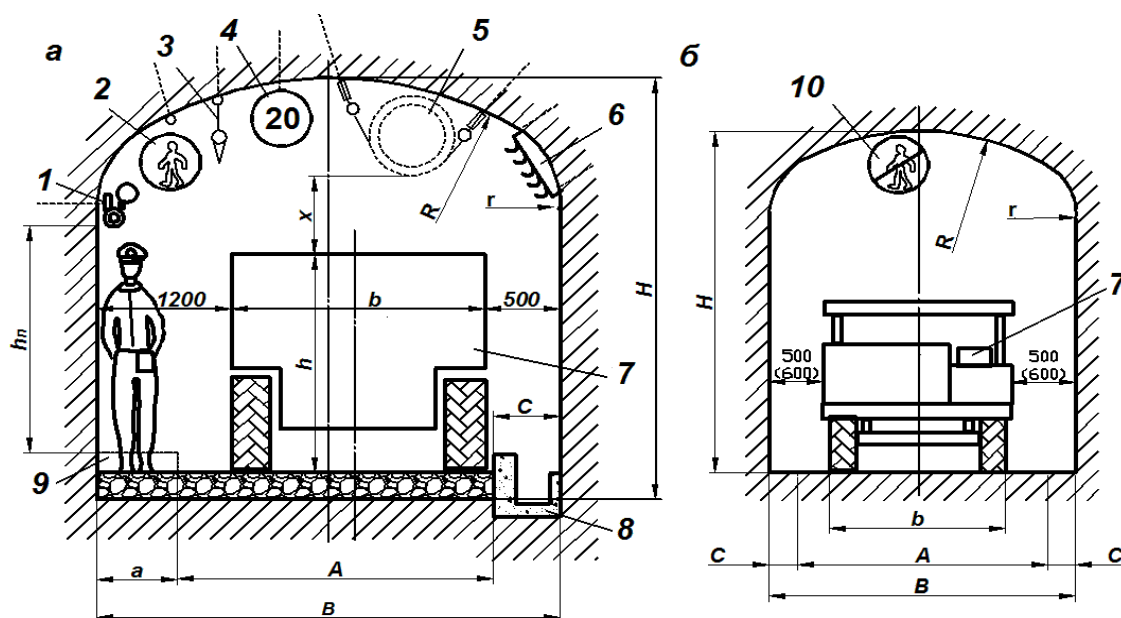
Поперечное сечение выработок для самоходного оборудования
